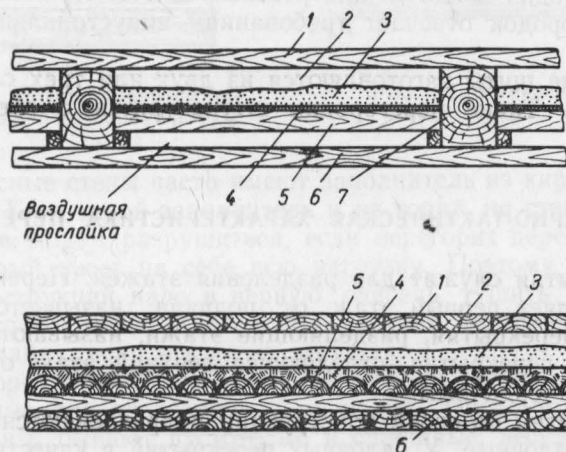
Междуэтажное перекрытие, не имеющее лаг:
